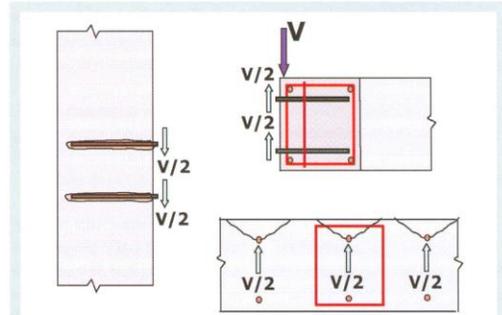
Comprobación de Rotura por borde de hormigón en viga perimetral.
